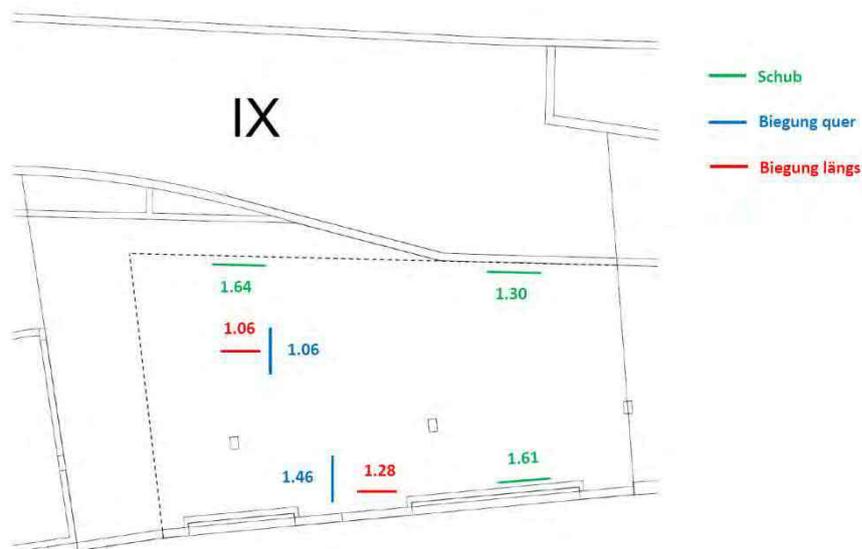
Nachweisführung für bestehende Decke Feld IX
